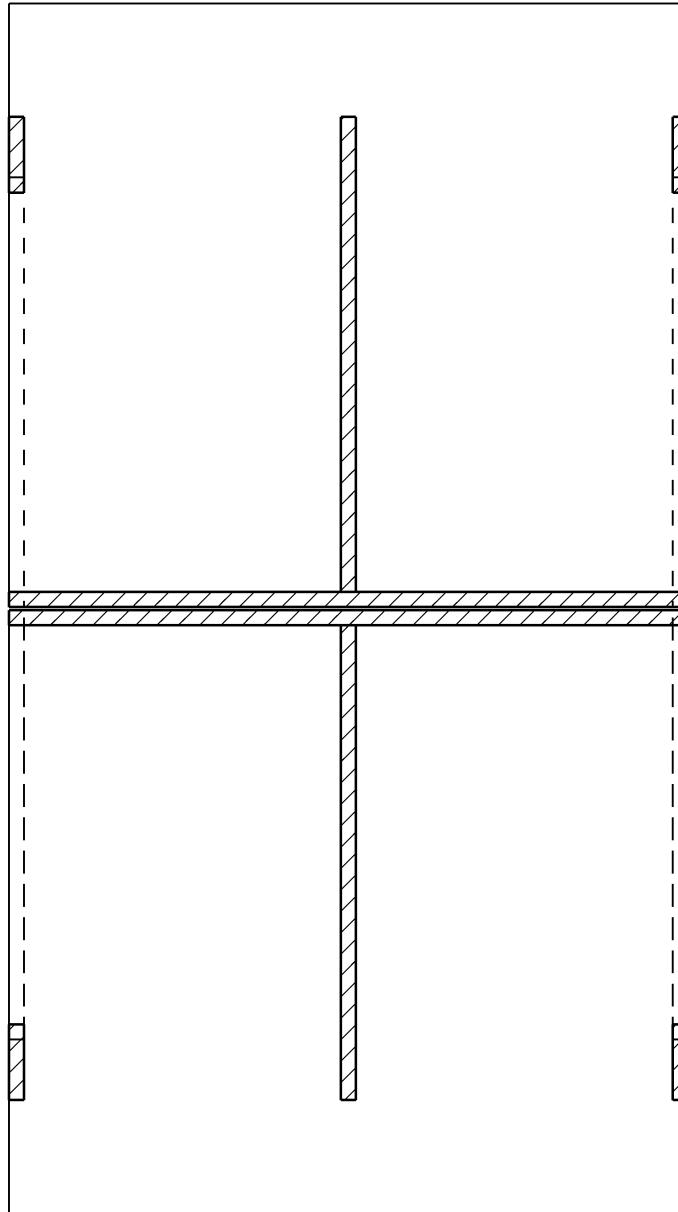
(d) Grundriss Stahlbetonplatte zu Aufgabe 2b)
